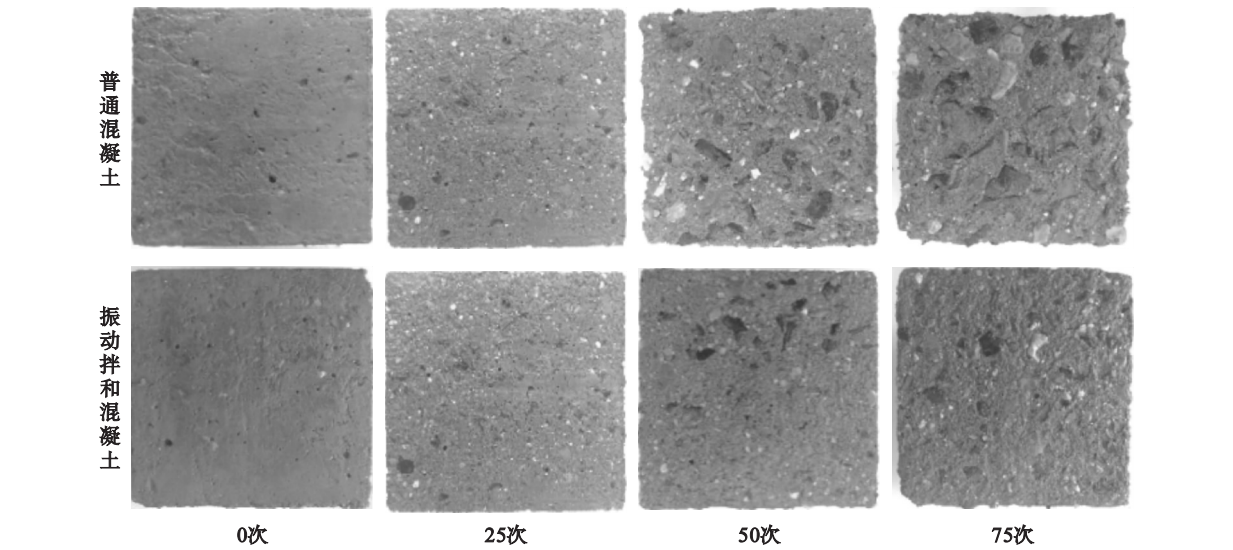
普通混凝土和振动拌和混凝土冻融破坏形态
